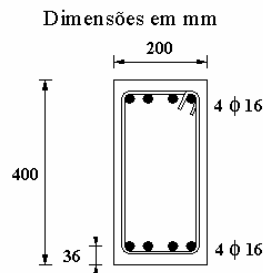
Seção transversal da viga do pórtico de Alva
